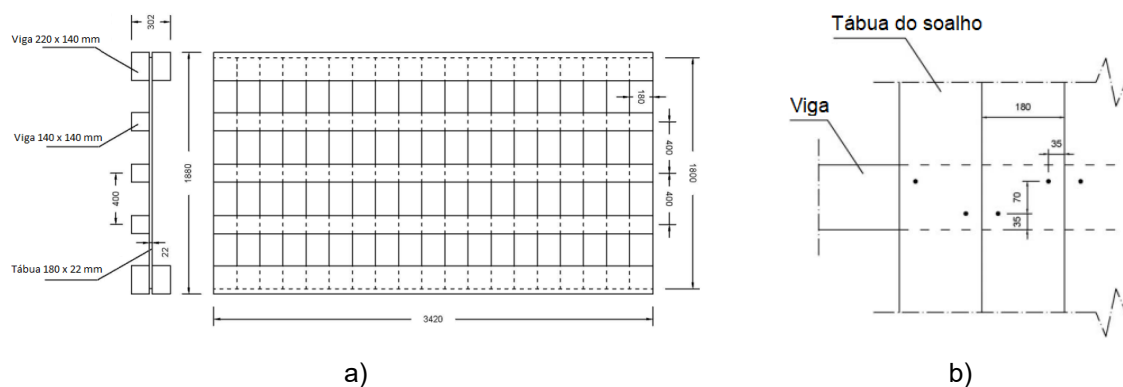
a) Visão geral do pavimento ensaiado por Fragomeli (2015) b) Disposição dos pregos nas intersecções com os vigamentos (Dimensões em mm) (Fragomeli, 2015)
